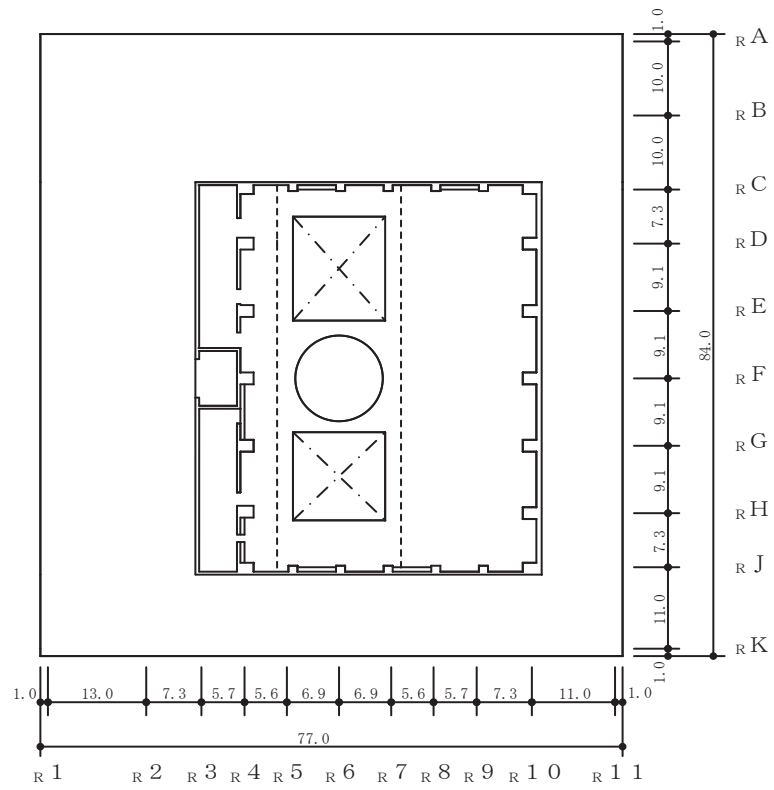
(4) 原子炉建屋の概略平面図 (0. P. 15.0m)
